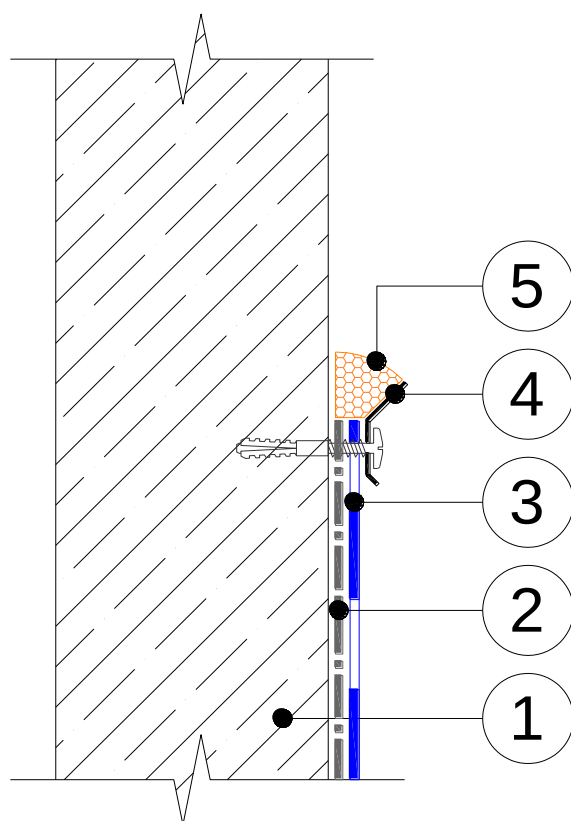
Раскладка кровельного материала при устройстве примыканий кровельного ковра к вертикальным поверхностям
